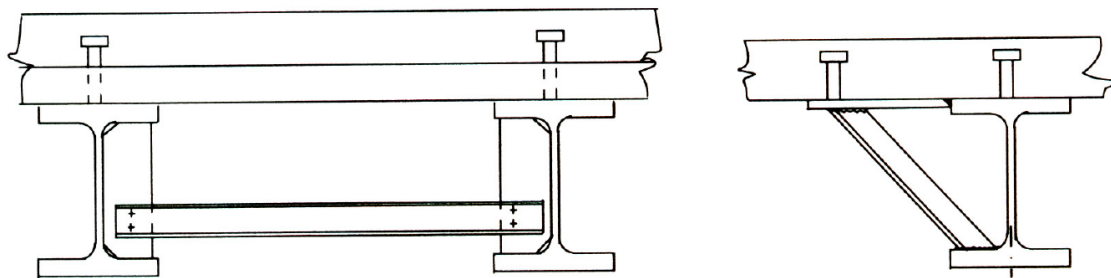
Примеры связей сталежелезобетонных балок в уровне нижнего сжатого пояса
